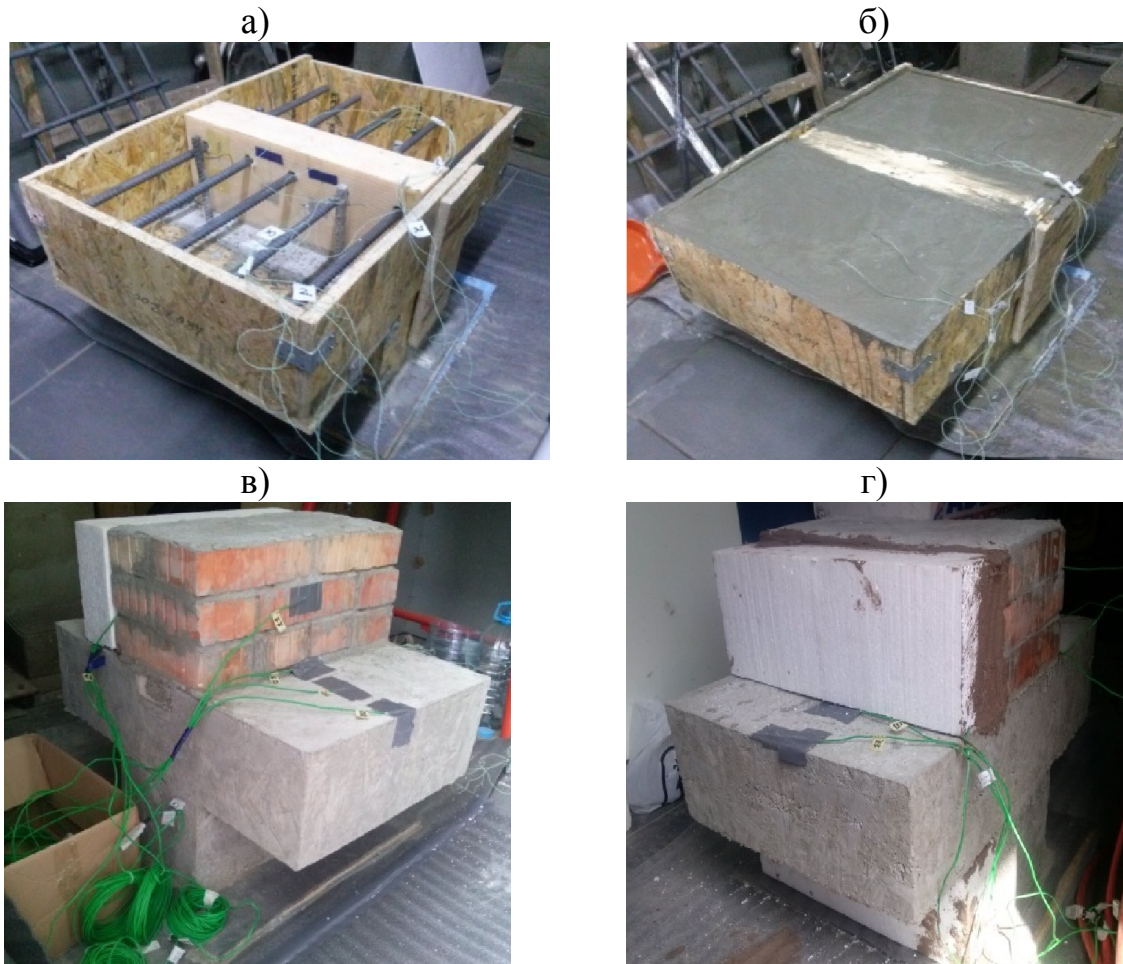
Спорудження зразків конструктивних вузлів «балконна плита – зовнішня стіна – плита перекриття»: а) встановлення додаткової теплоізоляції та заглиблених термопар у проектне положення, б) укладка бетону в конструкцію, в) готовий експериментальний зразок з додатковою теплоізоляцією та закріплені поверхневі термопари, г) готовий експериментальний зразок монолітного з/б поєднання плити перекриття з балконом та закріплені поверхневі термопари.
